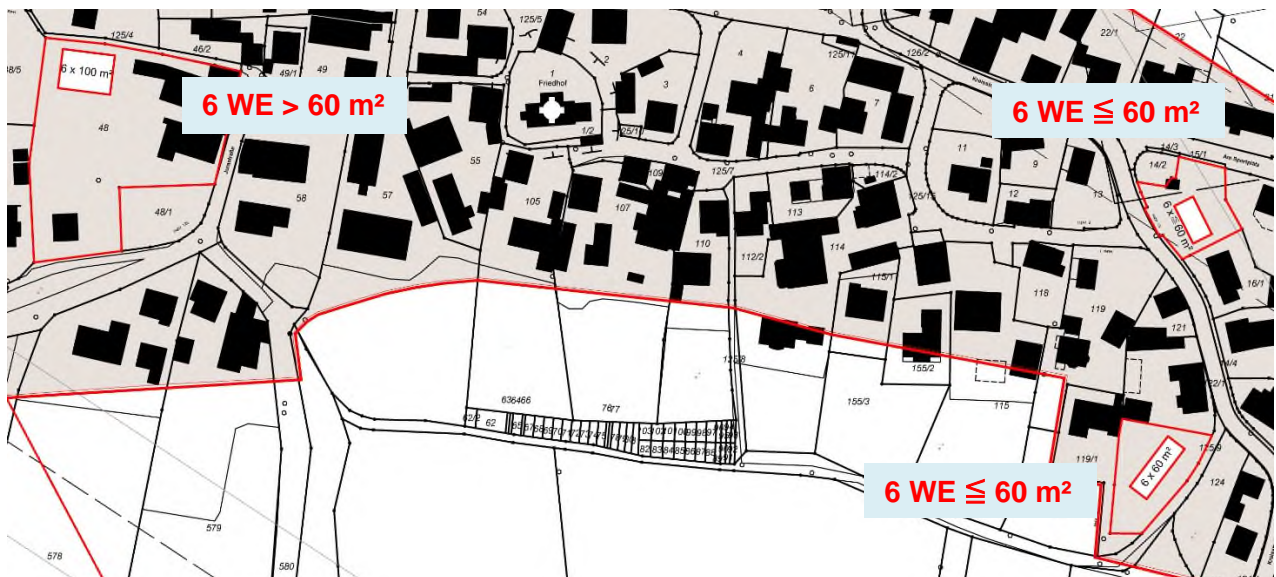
Bebauungsbeispiele Einzelhaus mit 6 Wohneinheiten Ausschnitt
